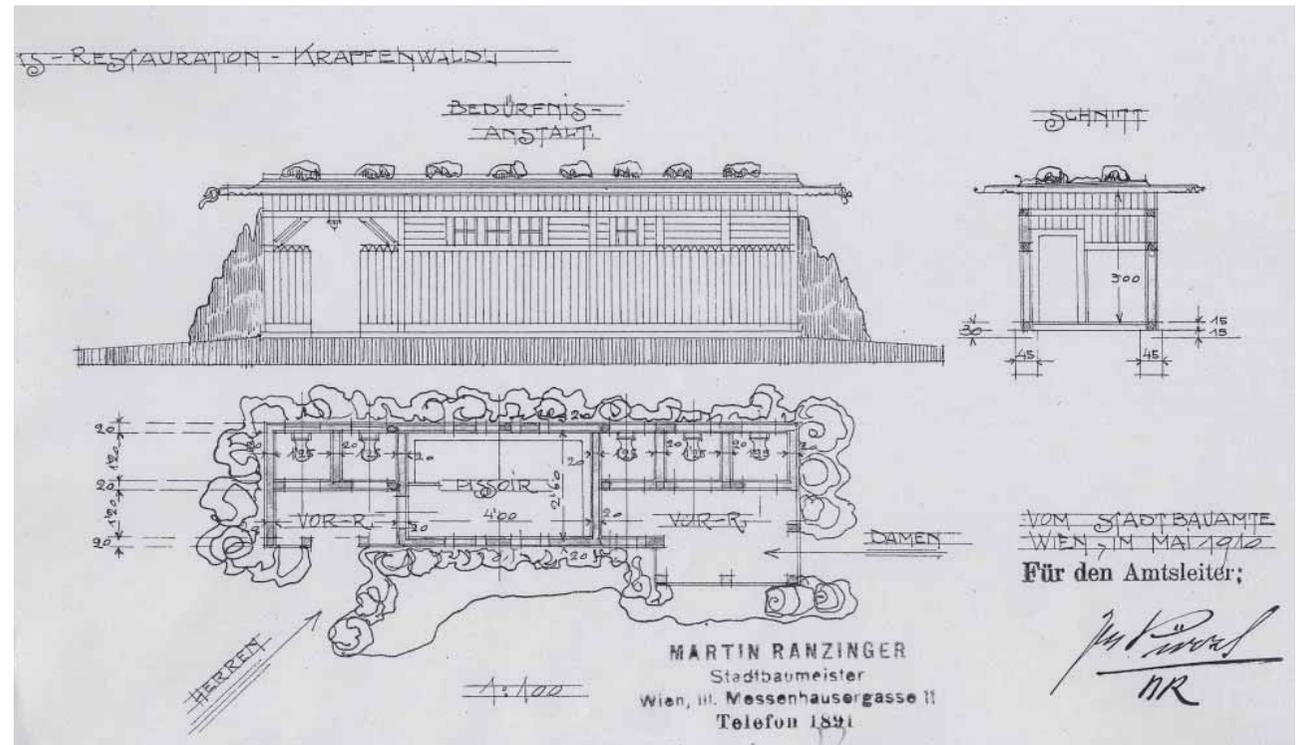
Plan Bedürfnisanstalt Krapfenwaldl
